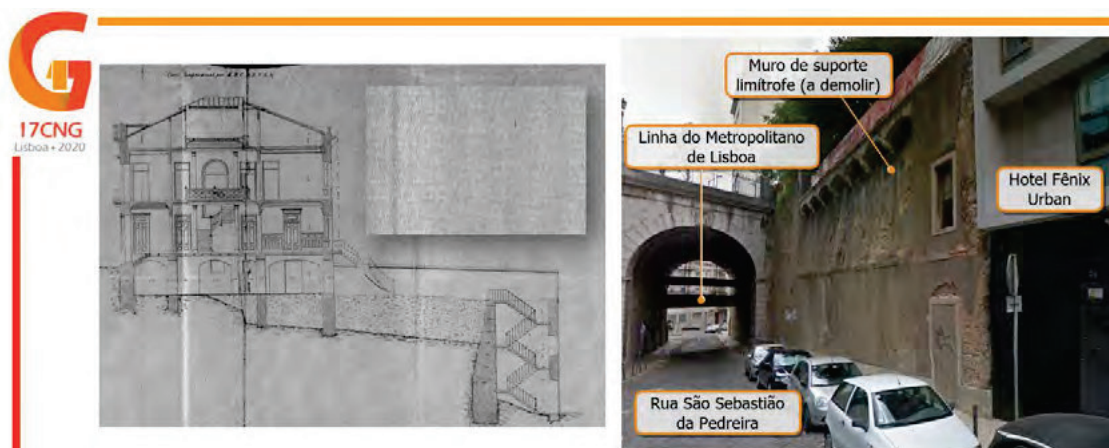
Corte das fundações do edifício pré-existente e vista da Rua São Sebastião da Pedreira - muro de suporte existente no interior do lote, a demolir
